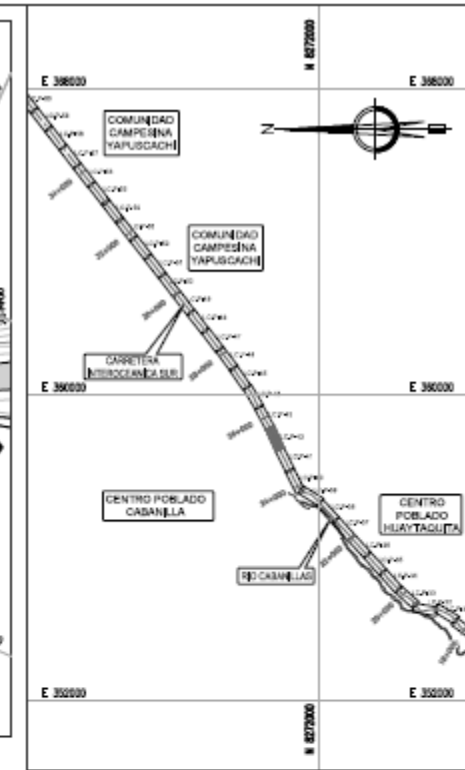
GERACION DE VISTA DE SECCIONES EN CIVIL 3D.
